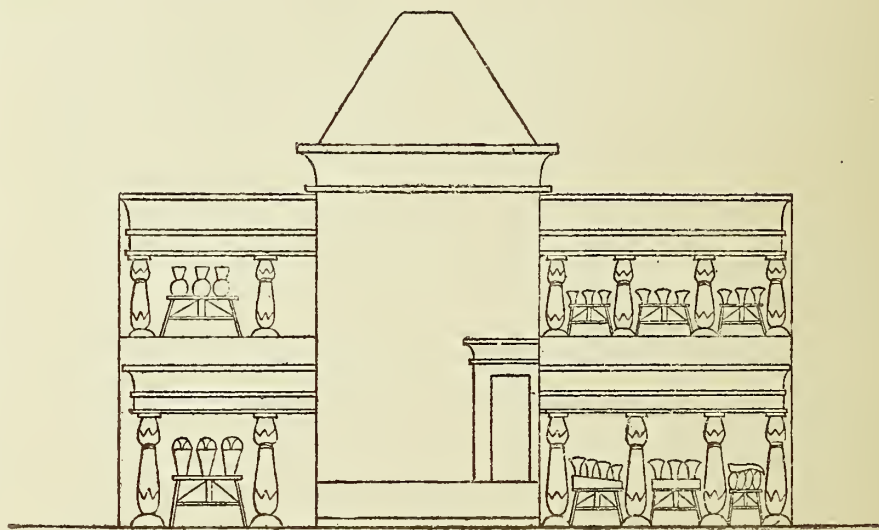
CASA CON TORRE CENTRAL Y GALERÍAS PORTICADAS
